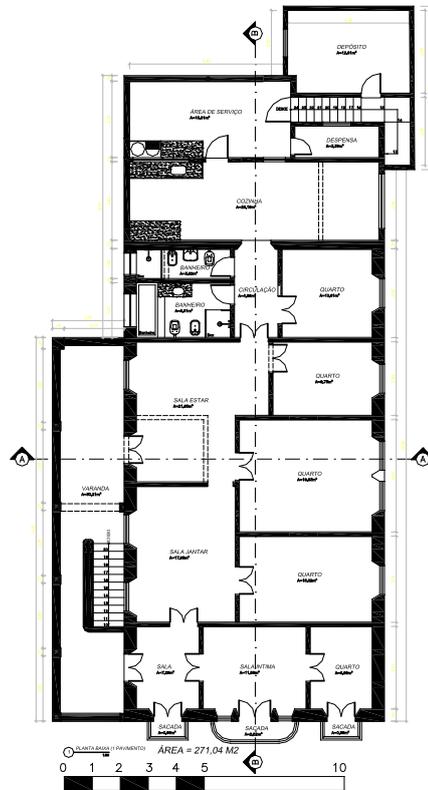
Planta segundo pavimento - Casa Ney Rambalducci
